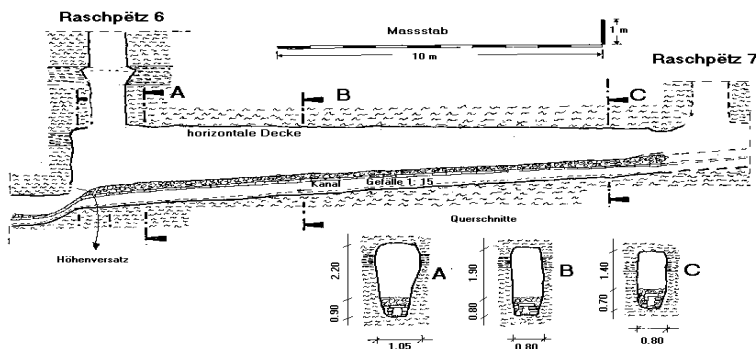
Galerie mit horizontaler Decke und nachträglich abgeschrägter Sohle
